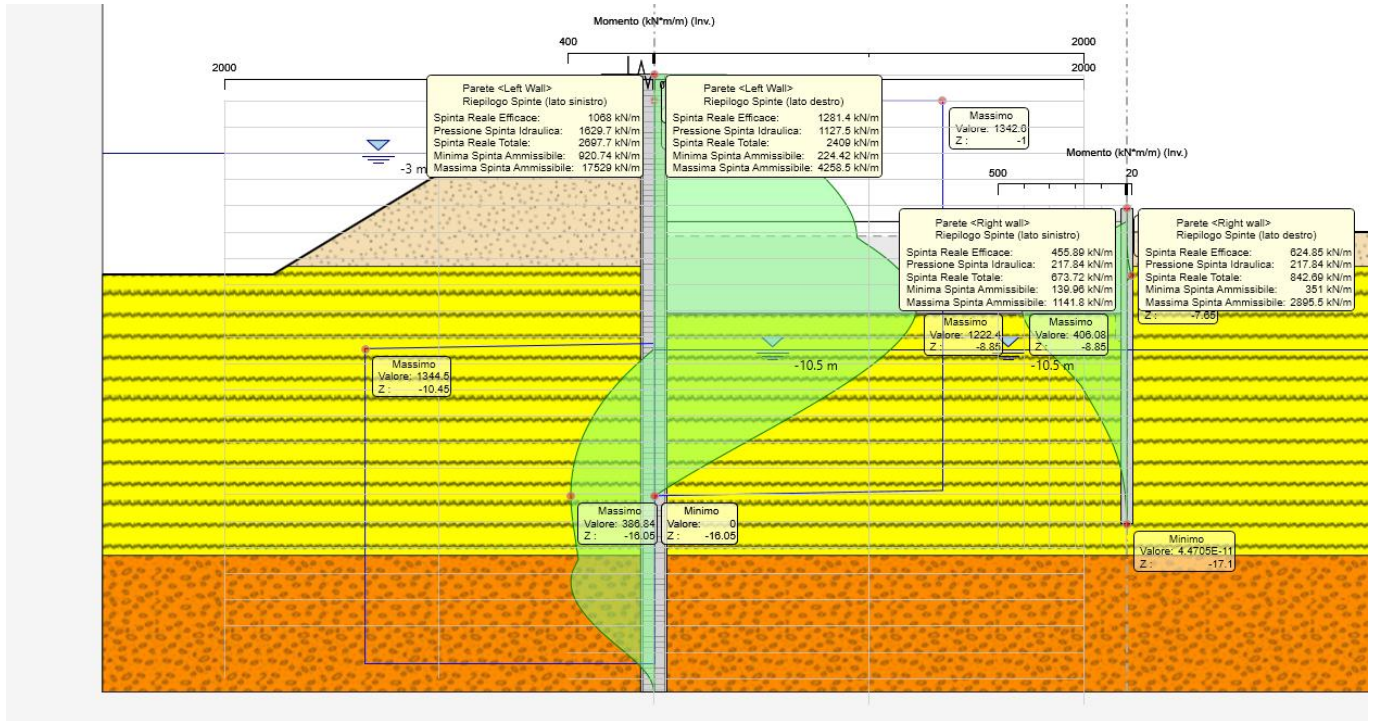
Sezione 1, Riepilogo spinte SLU GEO (A2+M2+R1) – fase 4
